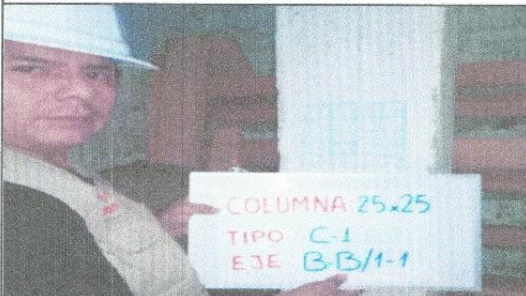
Columna ubicado en el 2do piso Eje B-B/1-1
